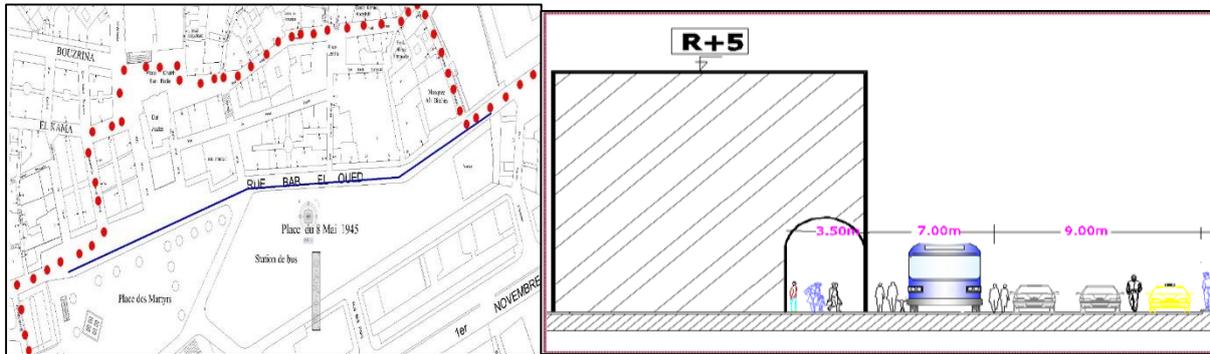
plan et coupe avenue Bâb el oued Bâb azzoune
